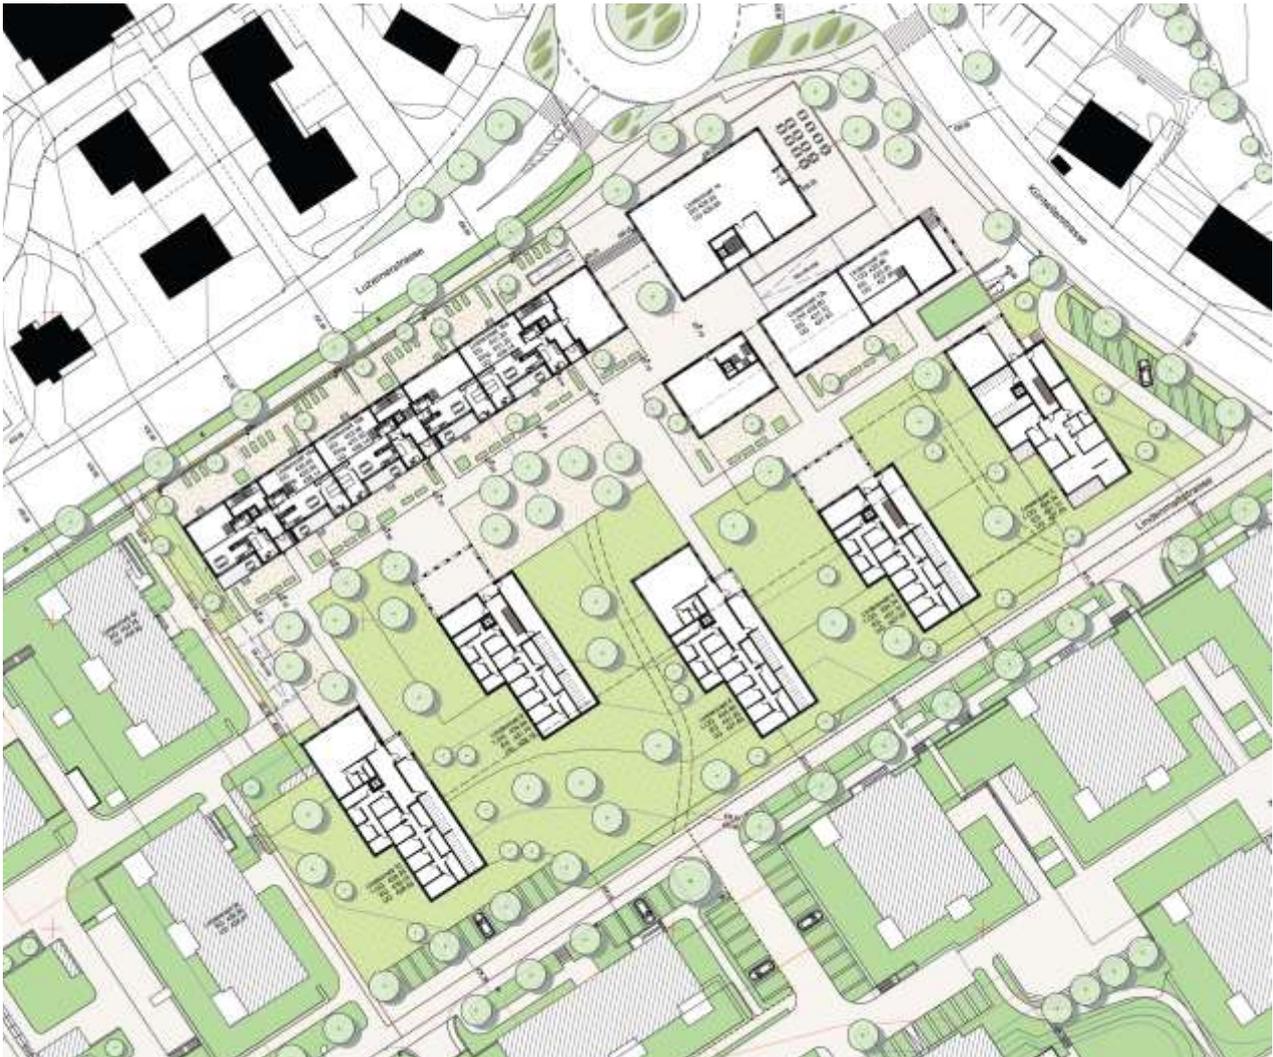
Plan Bauungskonzept, Erdgeschoss, Stand Juli 2013
